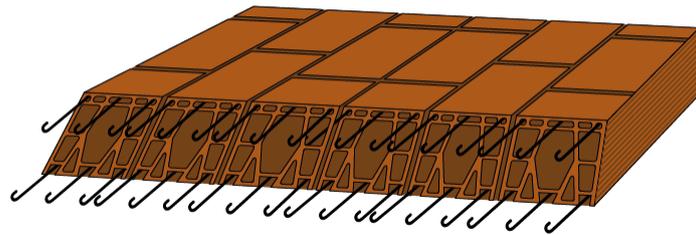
Esempio di solaio realizzato con travetti SAP
